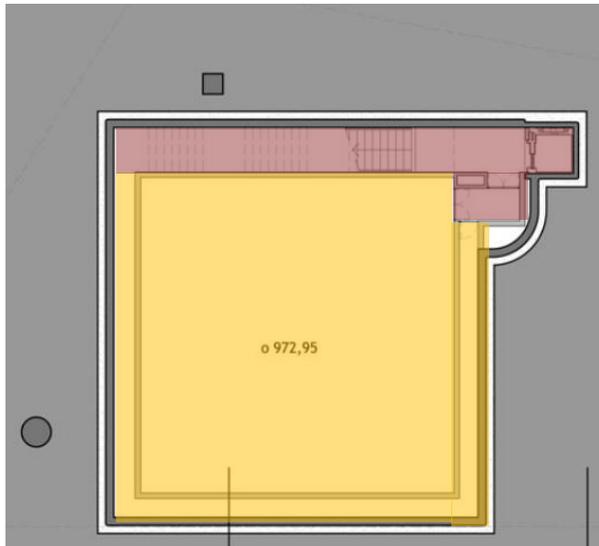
Planta baixa subsolo - Fonte: Archdaily D, 2019
